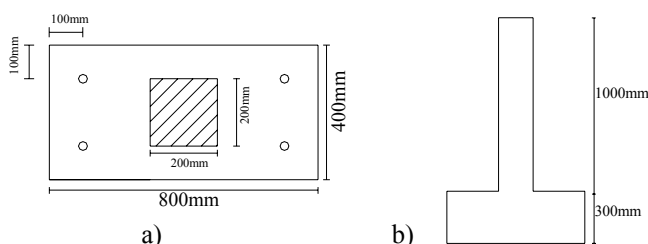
Geometria dos provetes (pilar/sapata): a) planta; b) alçado.
